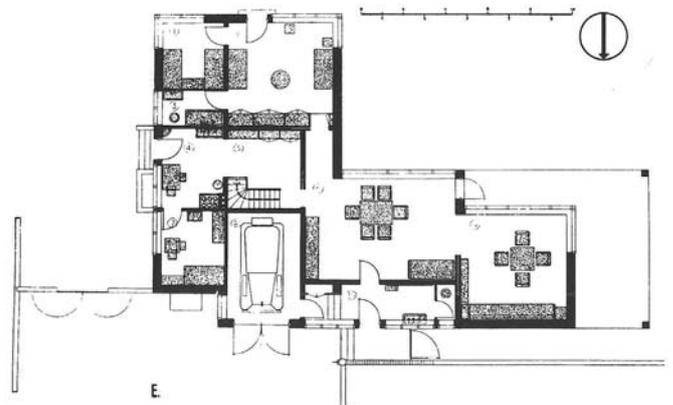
Erdgeschoss Grundriss Haus Bauer, o.D.
